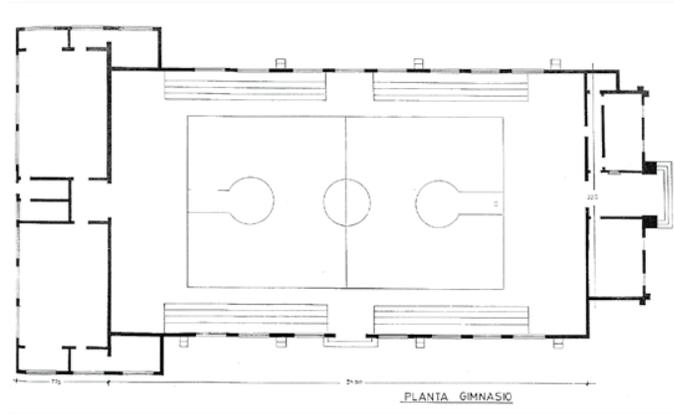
Gimnasio, planta según proyecto del arqto. H. Vega. Fuente: Aguayo y Navarro. 1993.
